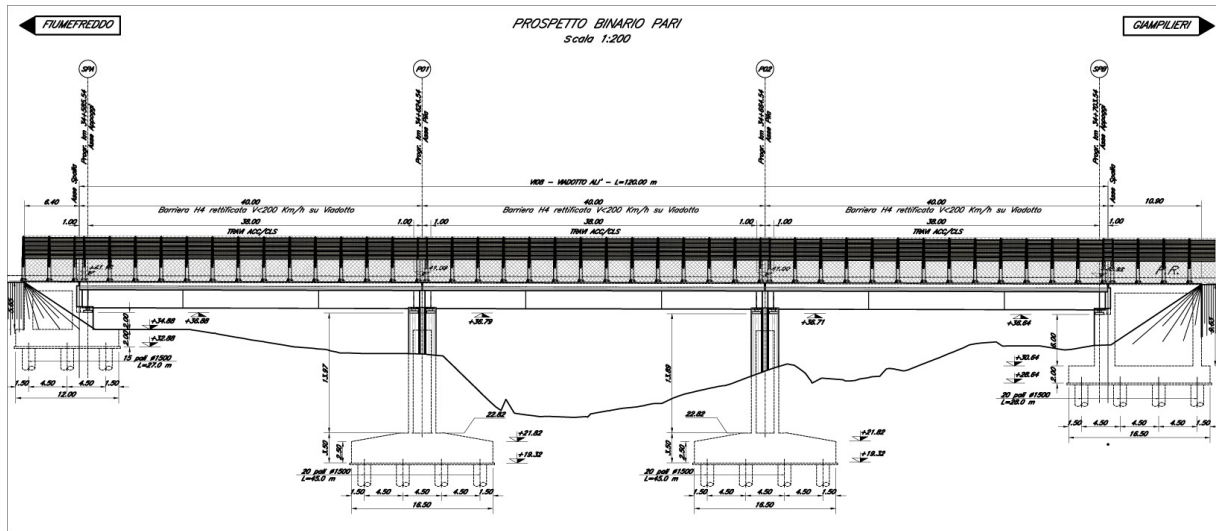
Viadotto Satano: sezione trasversale e prospetto binario pari
